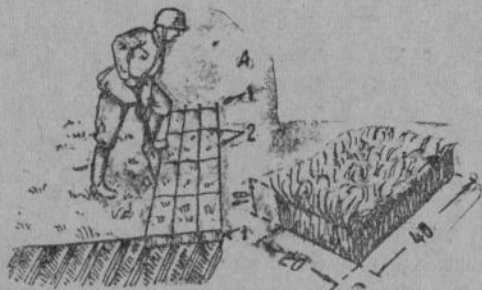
Дерьн и его заготовка дернинами и рулоном.
